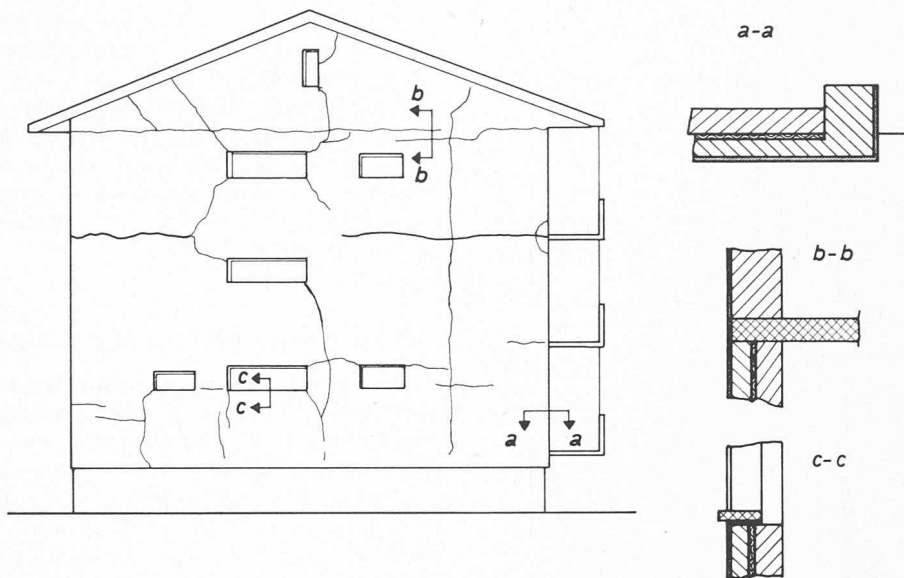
Fissuration du voile extérieur d'un mur-sandwich en maçonnerie, due à l'empêchement des dilatations thermiques différentielles.
